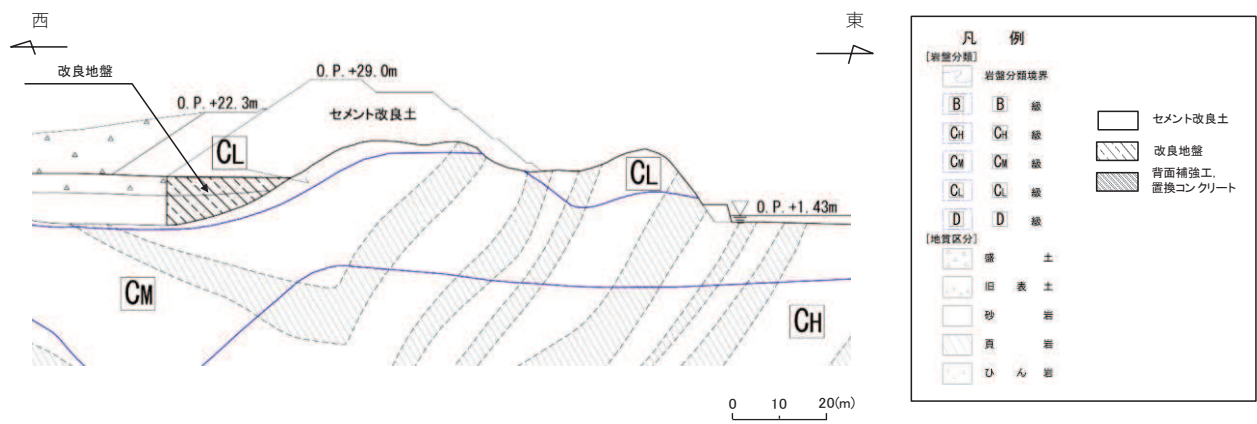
盛土堤防断面図 (I' 区間)
